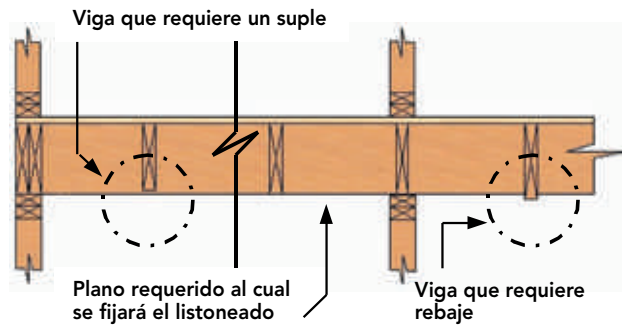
Corte de la plataforma donde se aprecia viga que requiere rebaje y viga que requiere de suplido.
